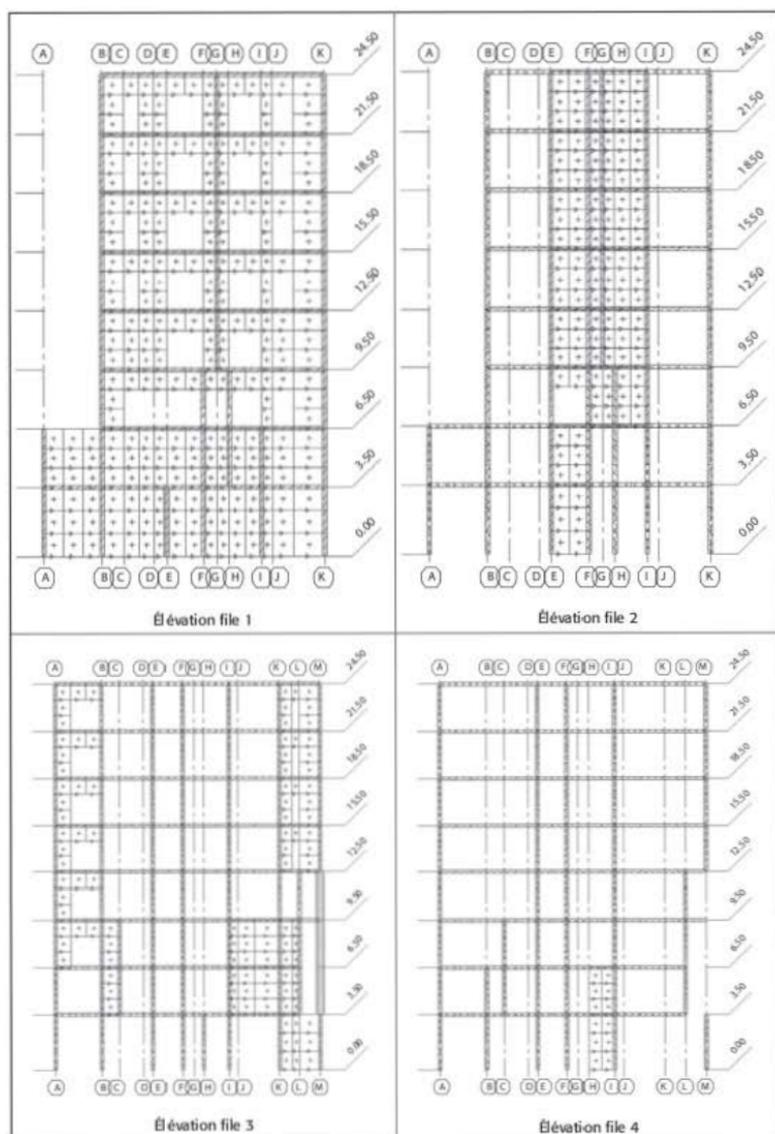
Élévation des voiles – plan YZ (1/3)
